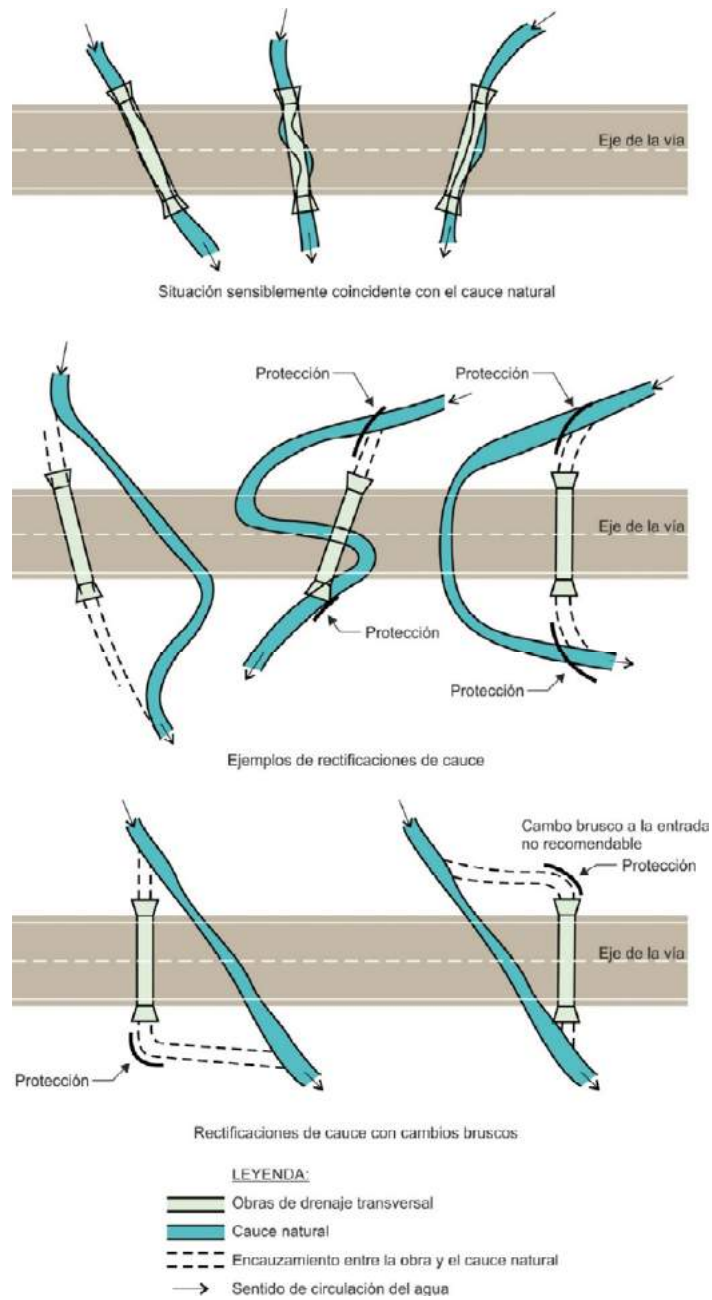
EJEMPLOS DE PLANTA DE OBRAS DE DRENAJE TRANSVERSAL
